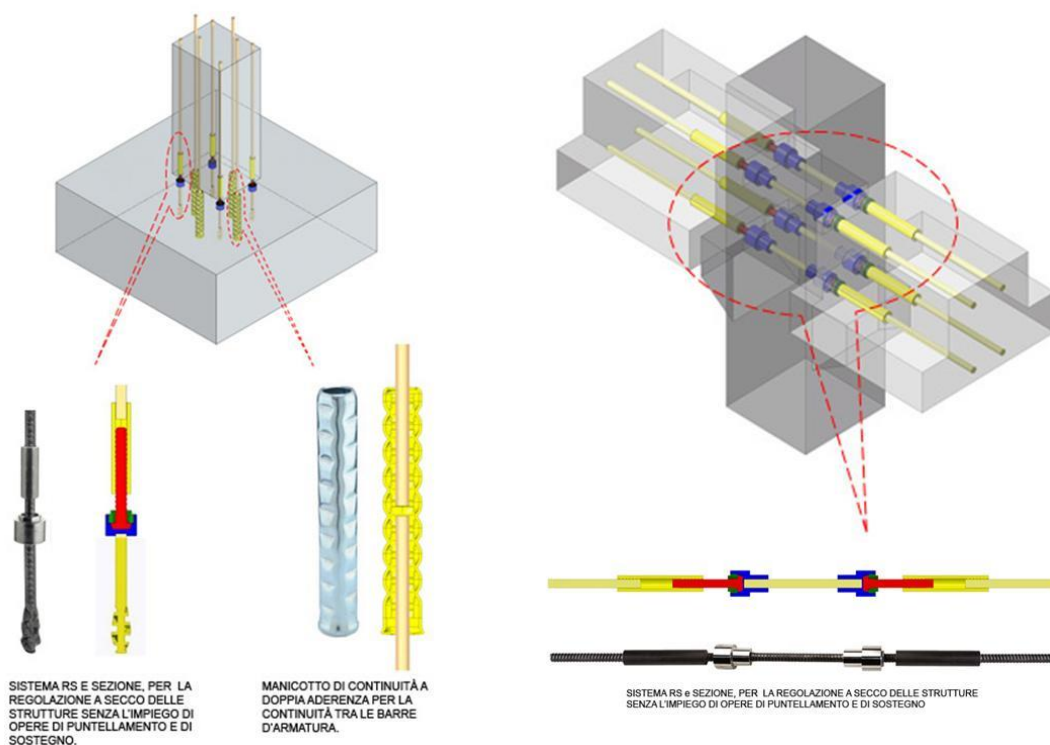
Esempificazione di un collegamento colonna fondazione e di un nodo trave colonna.
